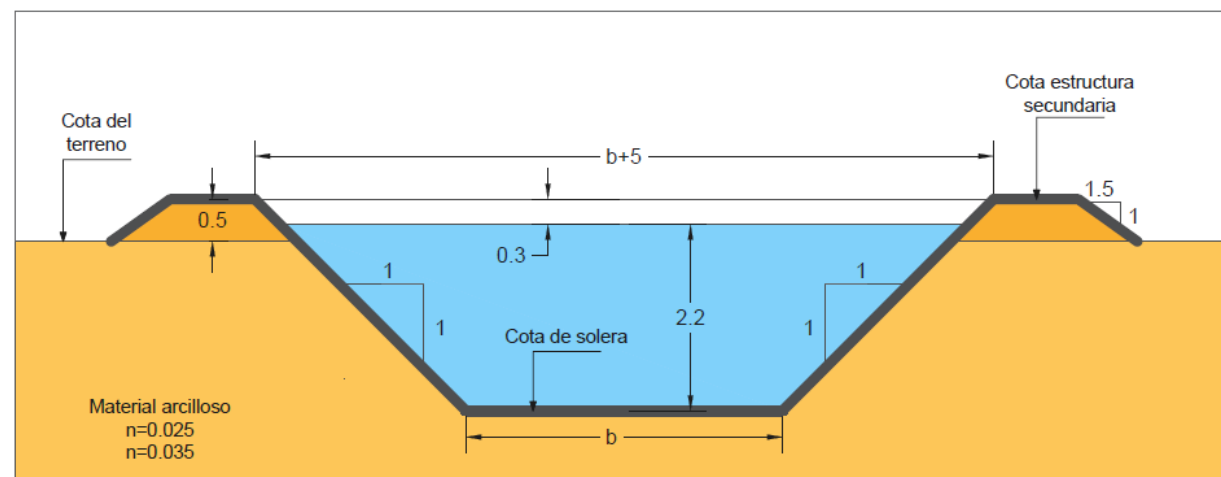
Sección trapezoidal tipo propuesta. [Fuente propia]
